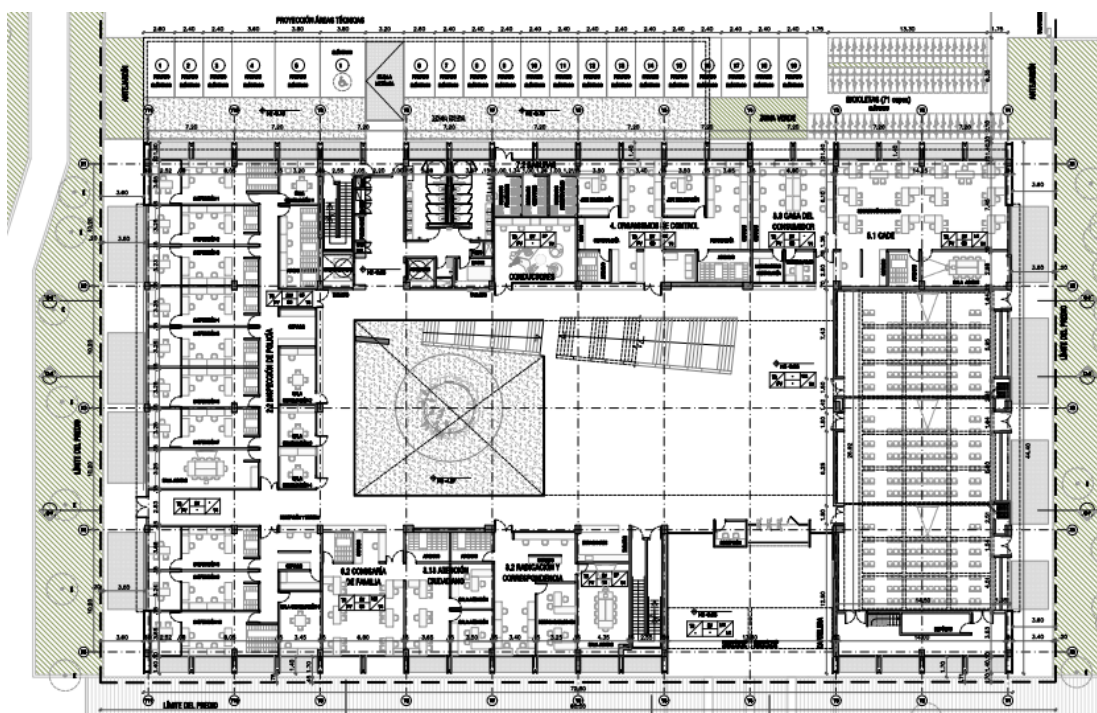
Planta piso 1. Fuente: Planos arquitectónicos.
